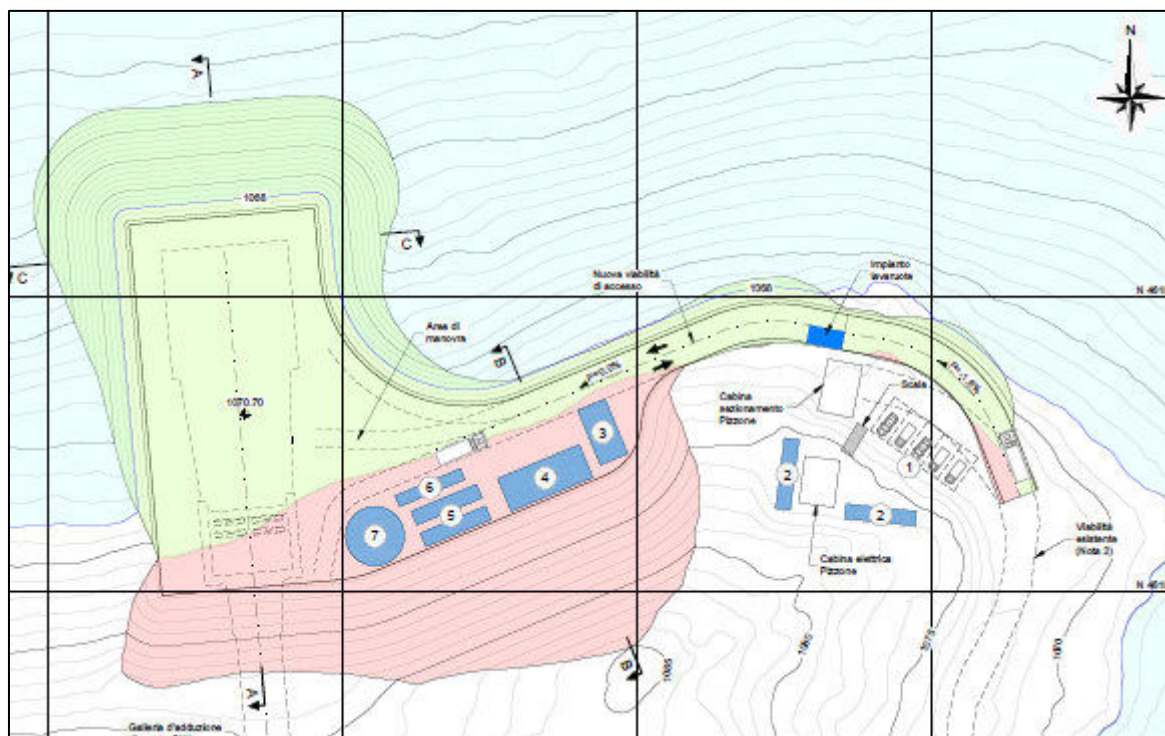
Ambito Alfedena - Area di cantiere C0.05 – Opera di presa di monte
